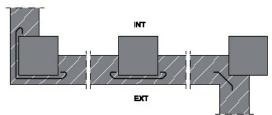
Ejemplo de encuentro de la fachada con los pilares
